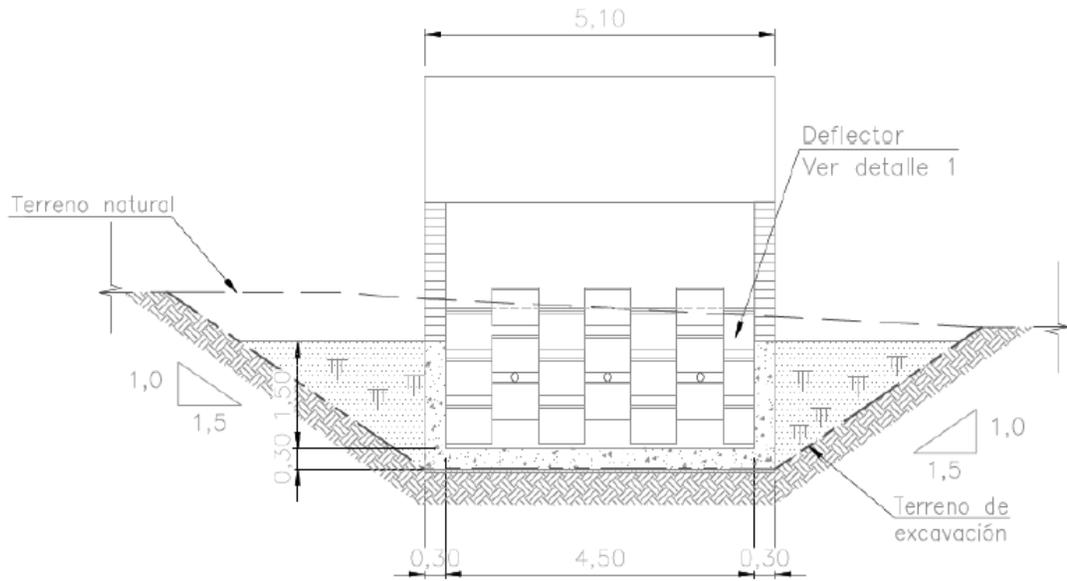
Plano en planta de la estructura de salida y descarga de la Estación de Bombeo de la Magdalena. Fuente: Radicado EAB ESP No. 2016ER58931.
